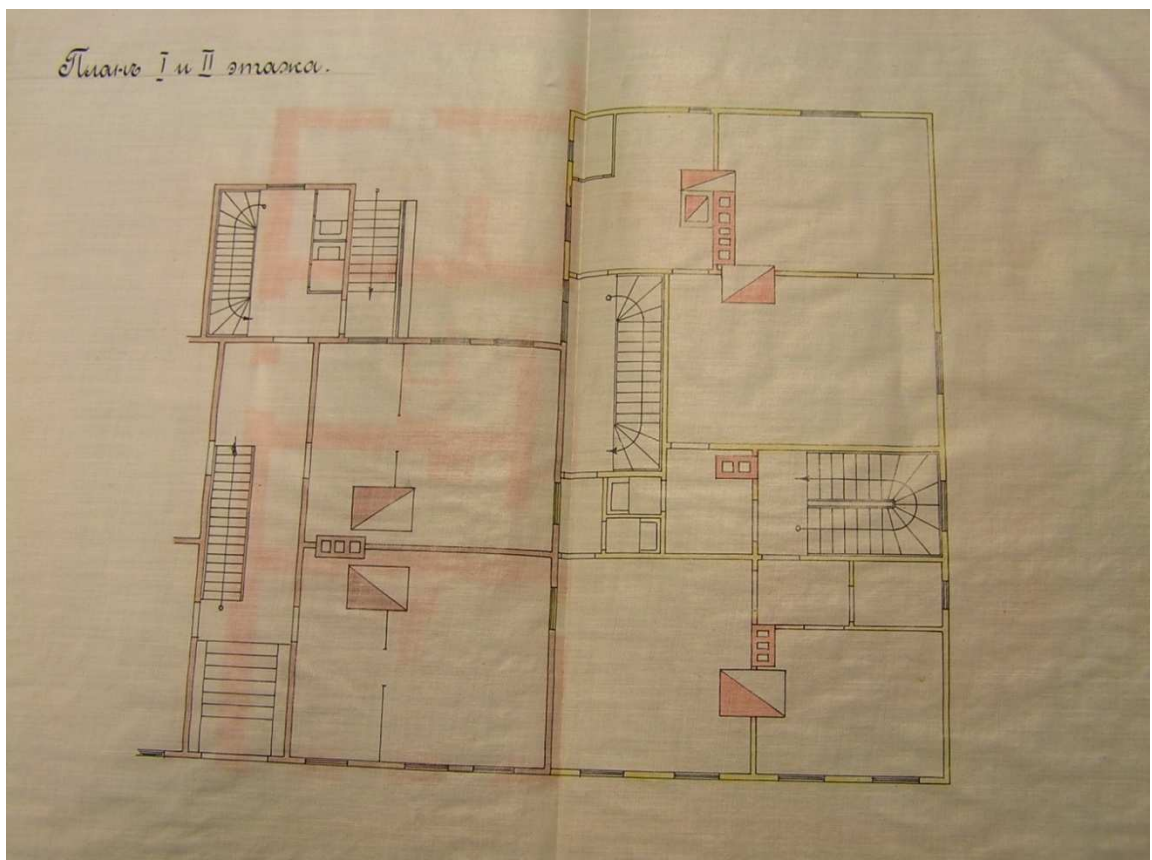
juurdehituse esimese ja teise korruse plaan, 1912. a – foto arhiividokumendist
